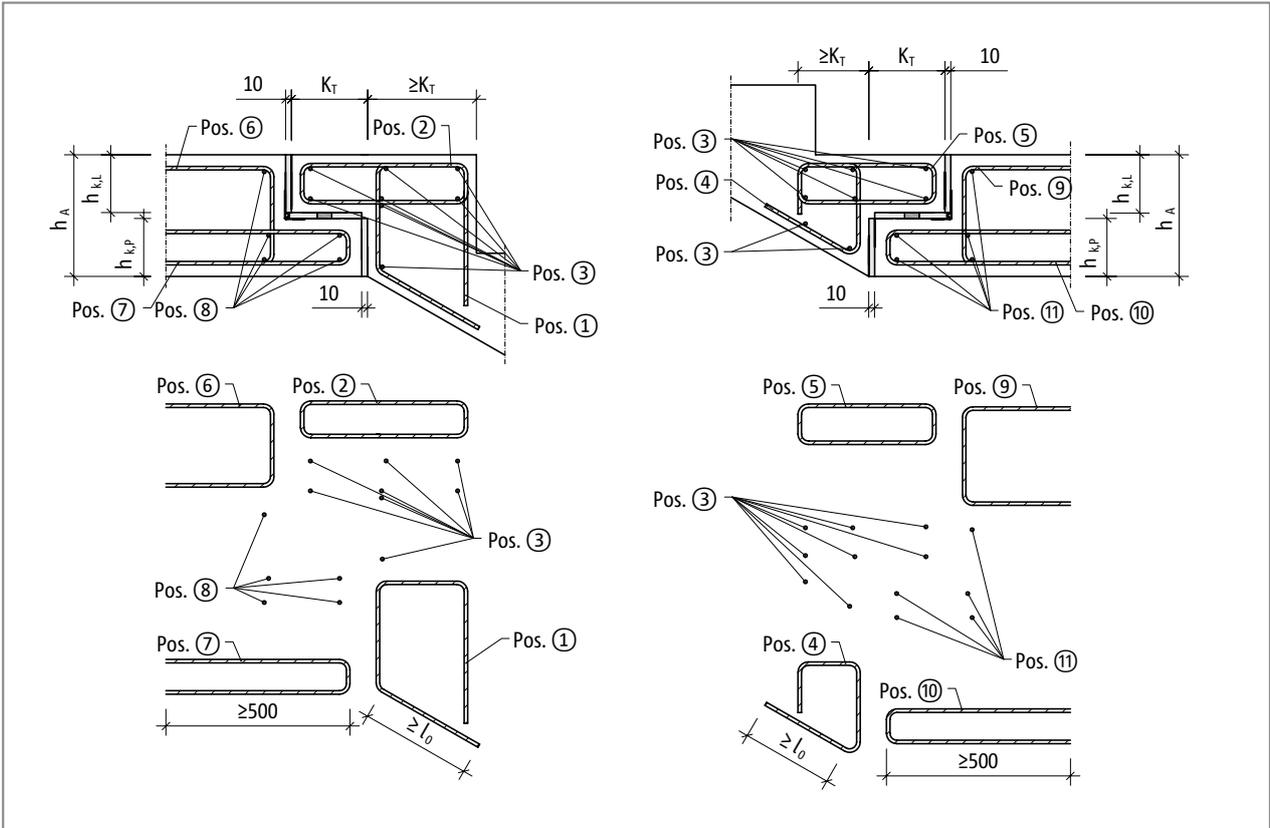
Schöck Tronsole® Typ F: Bauseitige Bewehrung bei bündigem Anschluss
